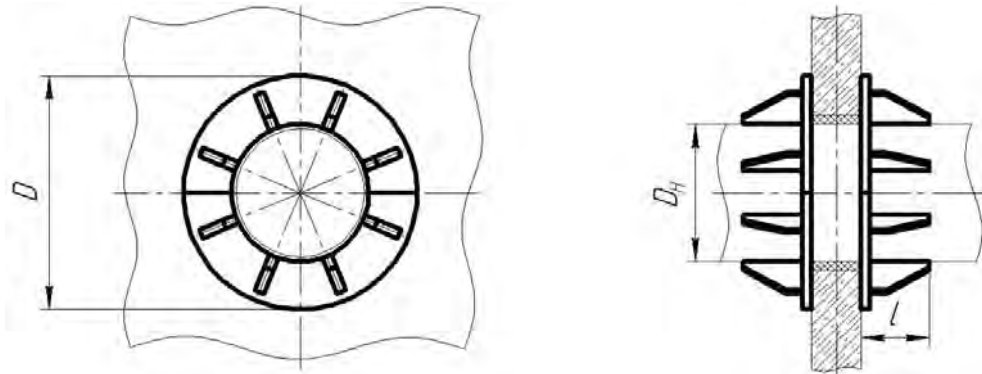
Опоры неподвижные щитовые (Т8)
